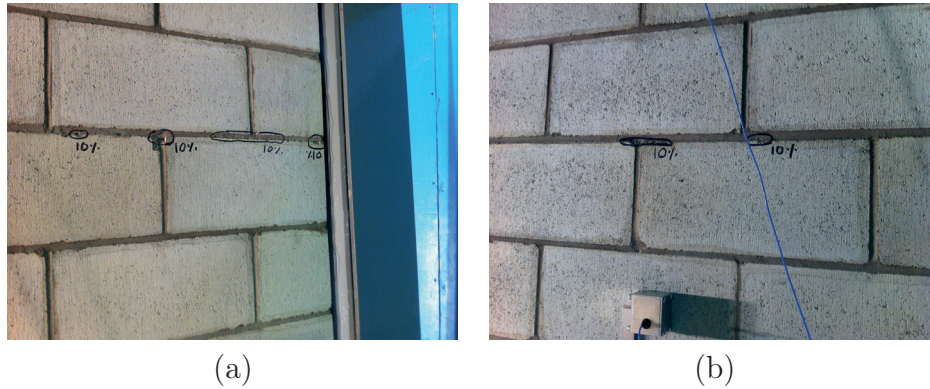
Photos des premières fissures observées sur la façade avant du mur 1 au niveau du 3<sup>e</sup> joint supérieur, après l'essai MAL4-0.10 (a) extrémité droite du mur (b) partie centrale du mur
